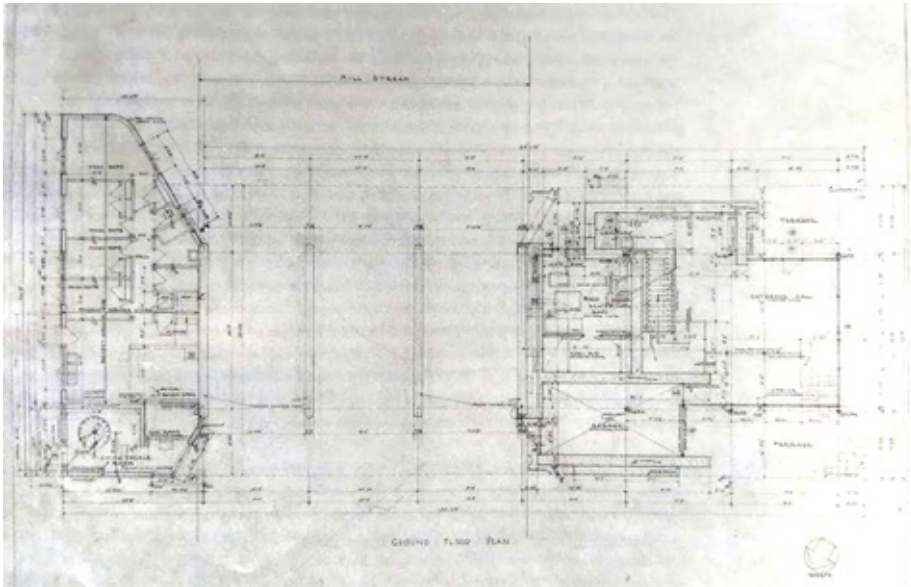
Planta Baja del proyecto definitivo de la Resor House.
